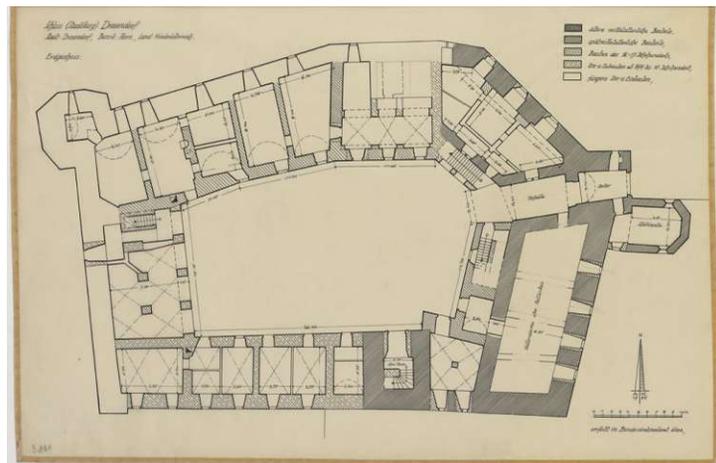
Grundriss 2.OG mit Bauphasen (1955)
